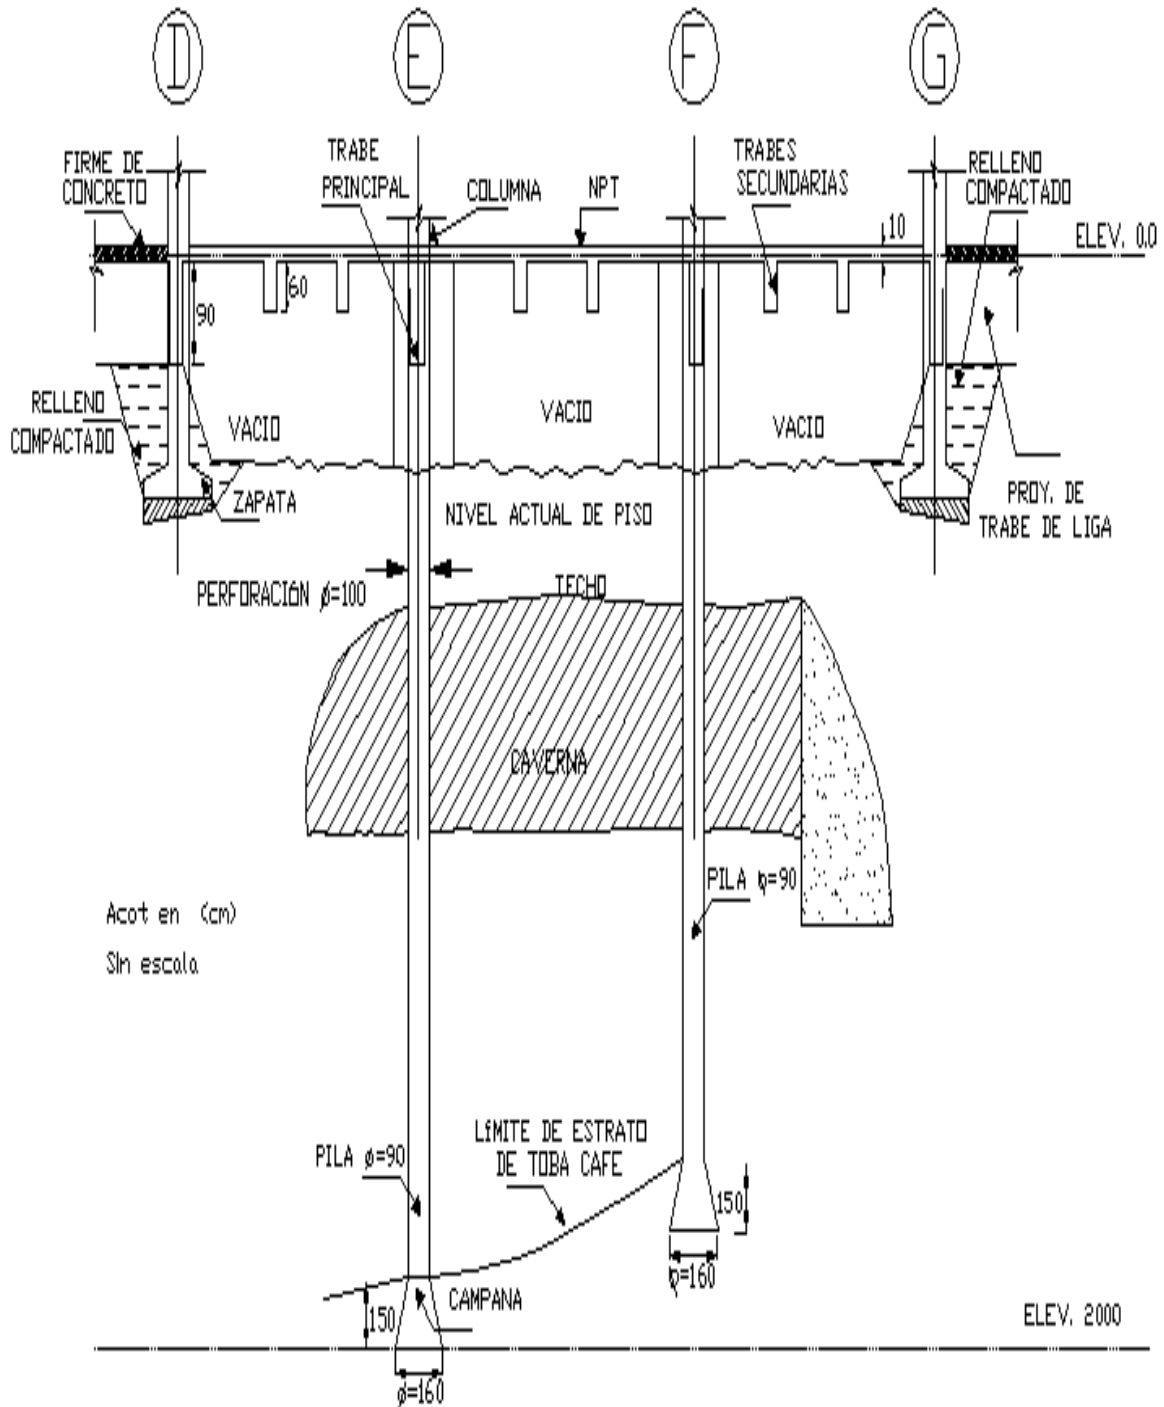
Pilas y zapatas desplantadas en zonas minadas (Sociedad Mexicana de Mecánica de Suelos, 1992)
